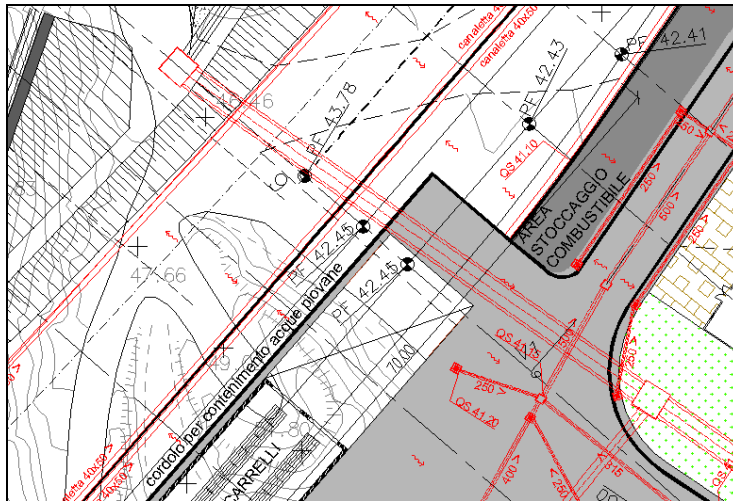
stralcio planimetrico attraversamento idraulico 2.00x2.00
